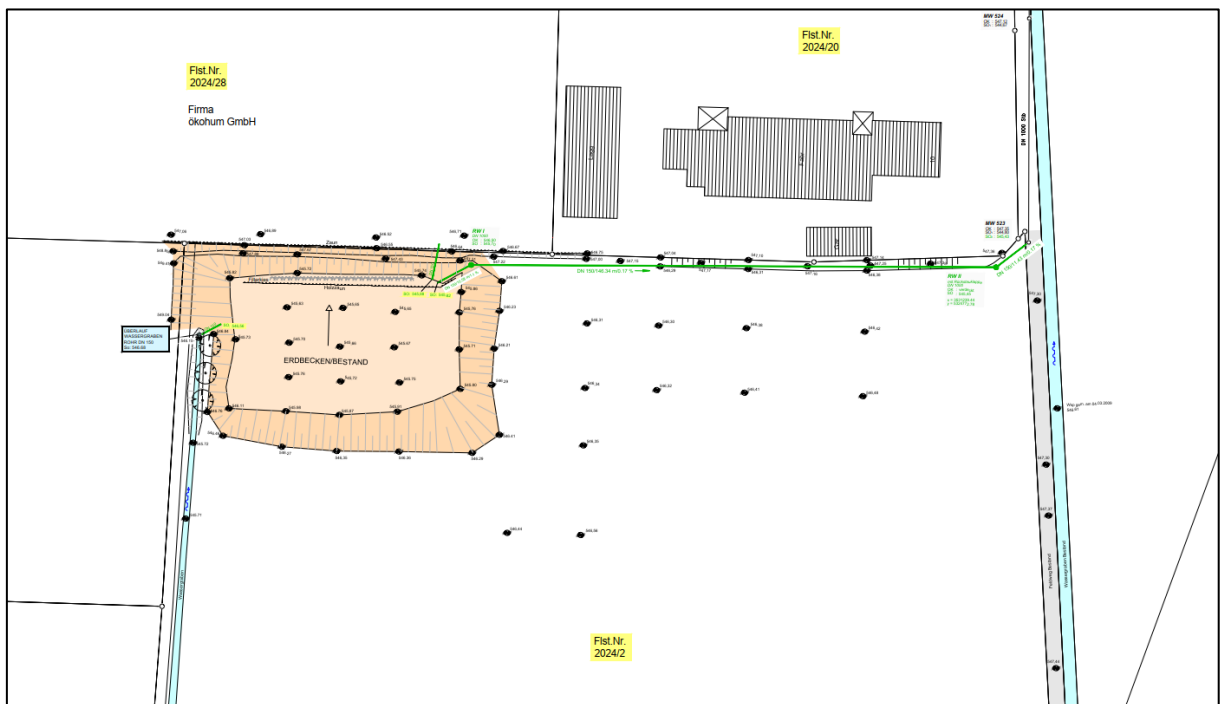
Bestandsplan zur Oberflächenentwässerung mit Sickerbecken, rechtskräftiger Bebauungsplan Industriegebiet „Obere Bergen“
